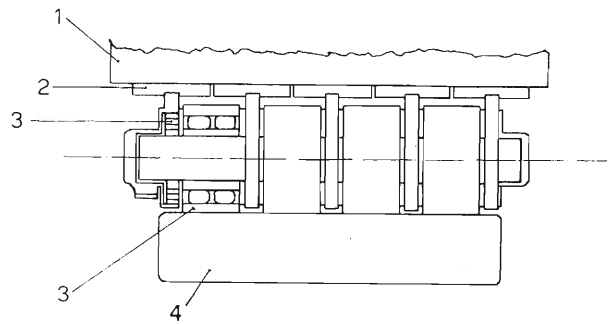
Costituzione degli elementi di spallamento.
